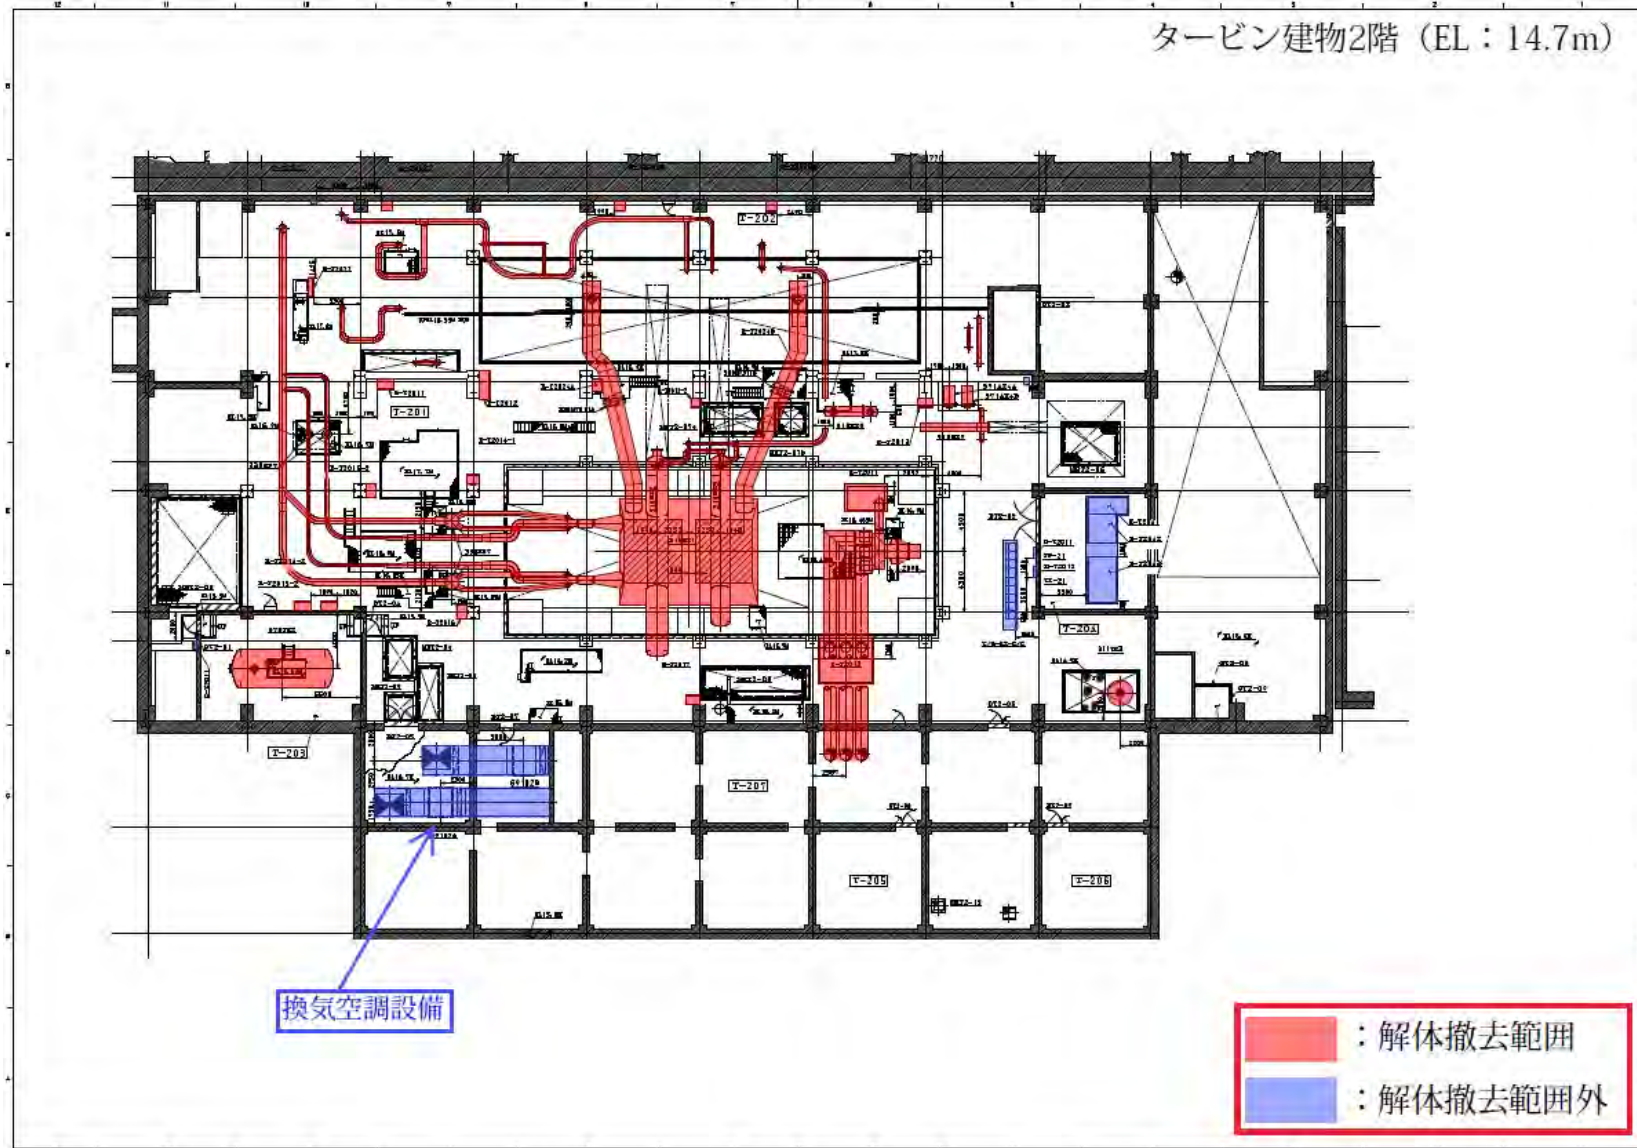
主な解体撤去機器 (タービン建物平面図) (5/7)
